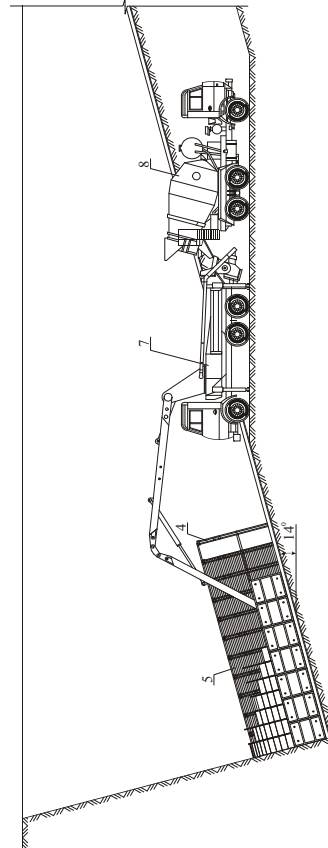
Укладка бетонного раствора за опалубку: арматурный каркас из: 1 – спецпрофиля СВП; 2 – гибкой арматуры; 3 – автобетононасос; 4 – автобетономешалка
